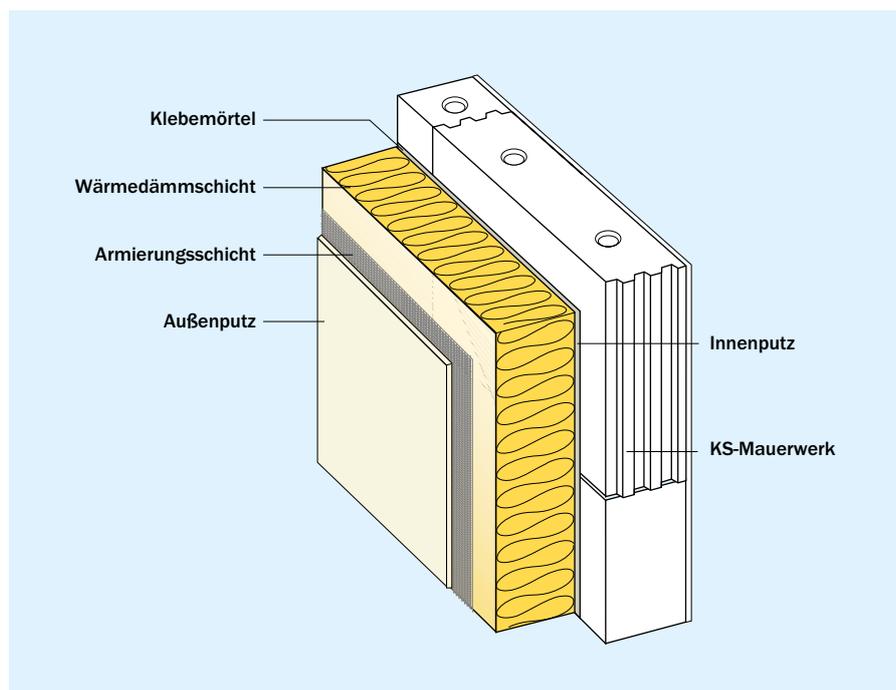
Wandaufbau KS-Mauerwerk mit Wärmedämm-Verbundsystem
